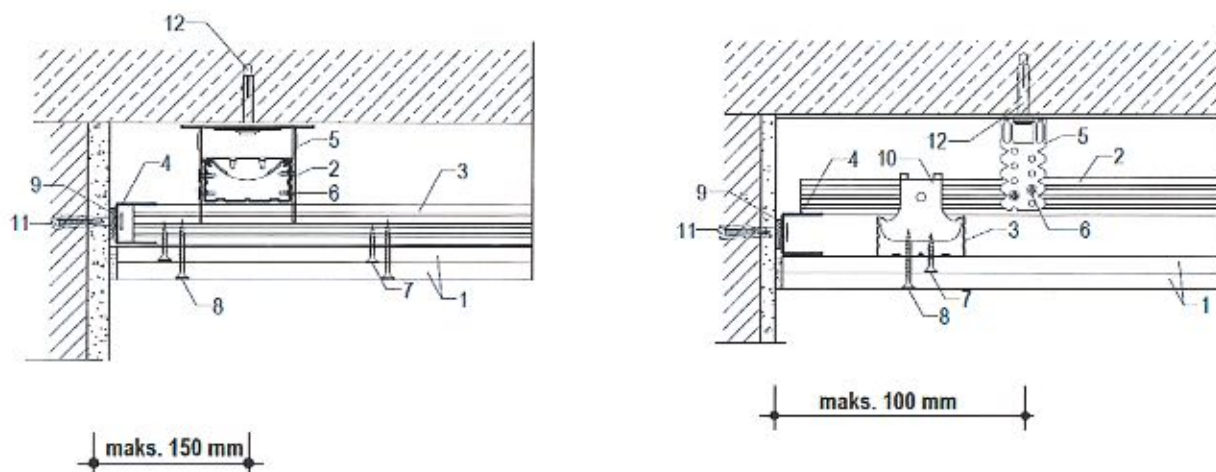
Przekrój podłużny sufitu podwieszanego - konstrukcja krzyżowa dwupoziomowa
